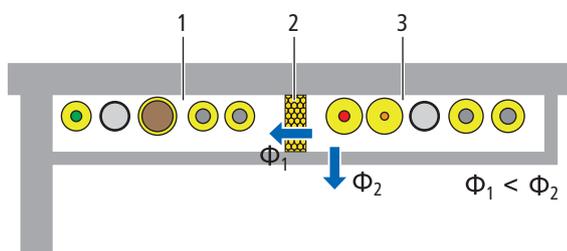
Vano tecnico o sistema di parete con parete divisoria termica
